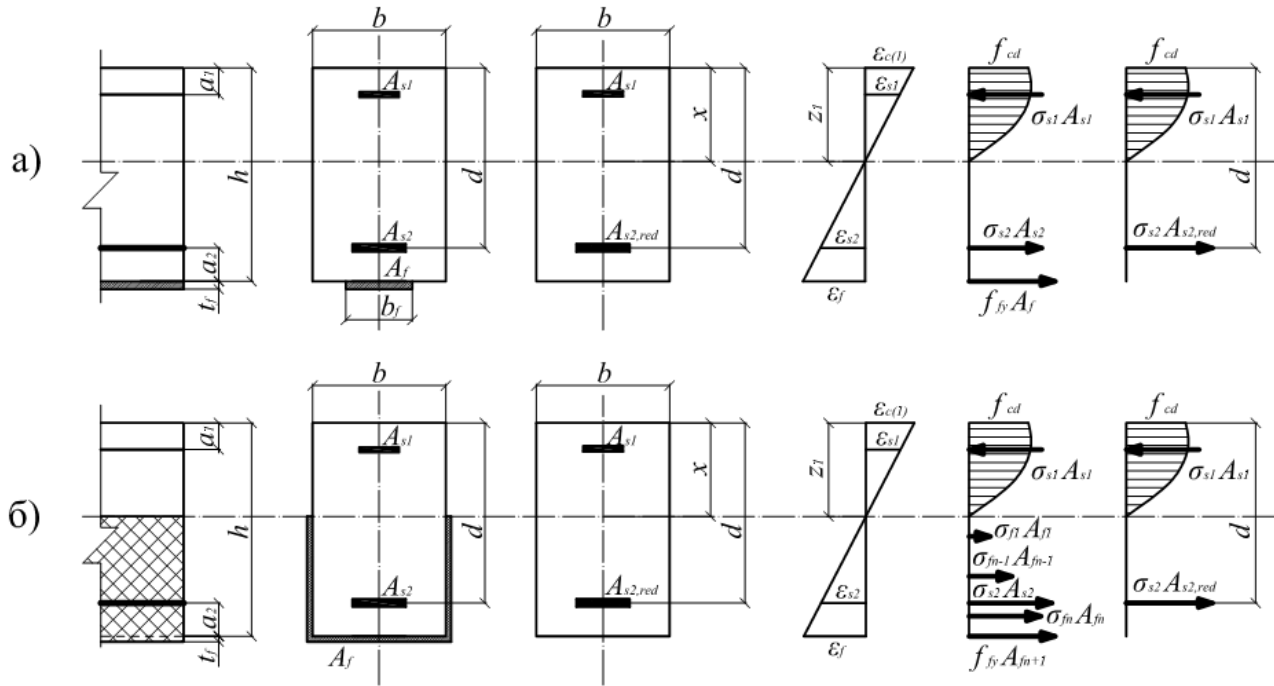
Розрахункова схема нормального перерізу залізобетонної балки підсиленої:
